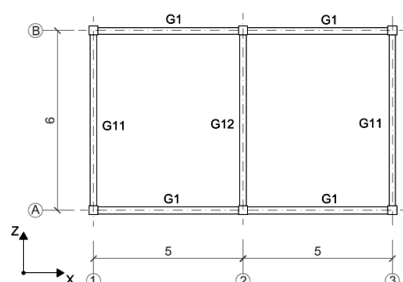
Planta da estrutura do edifício de 4 pisos.
